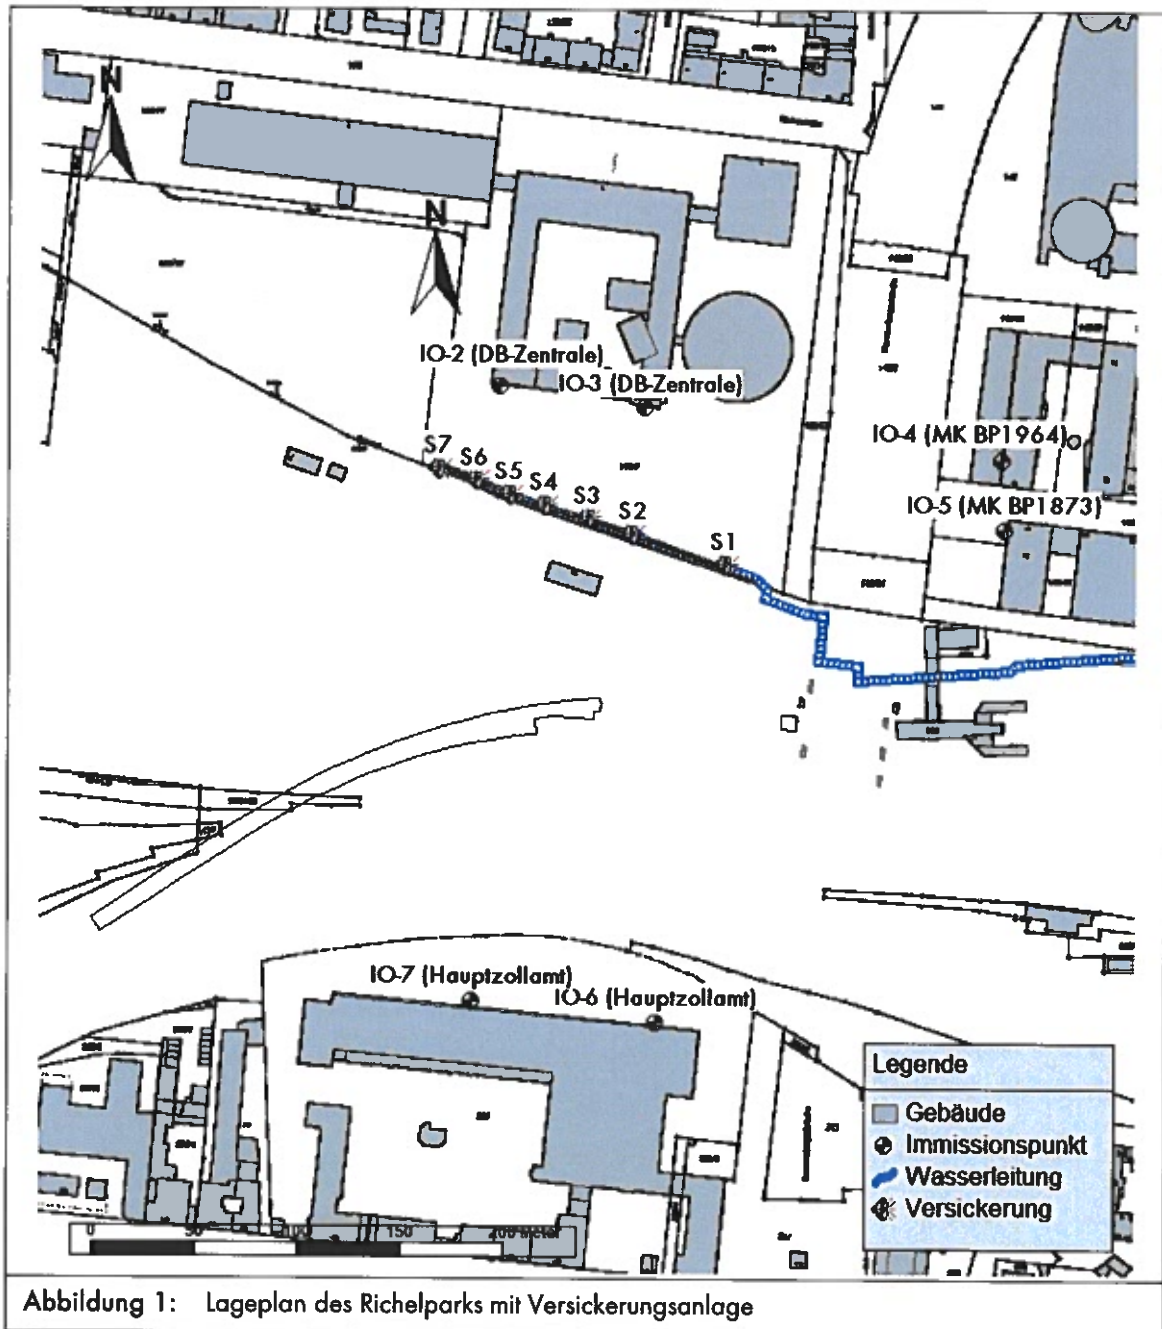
Lageplan des Richelparks mit Versickerungsanlage
